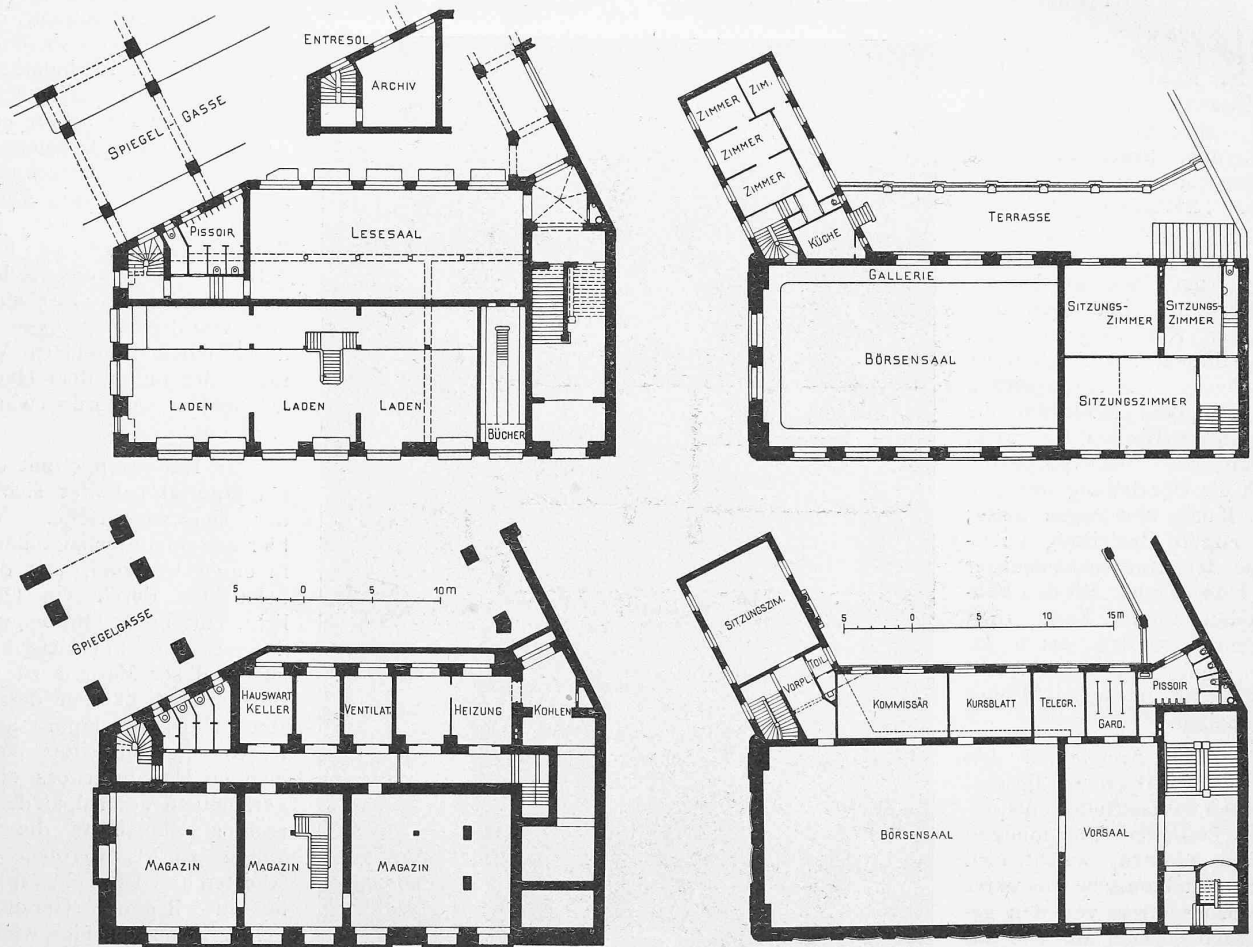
bis 5. Grundrisse vom Keller- und Erdgeschoss sowie vom ersten und zweiten Stock.
